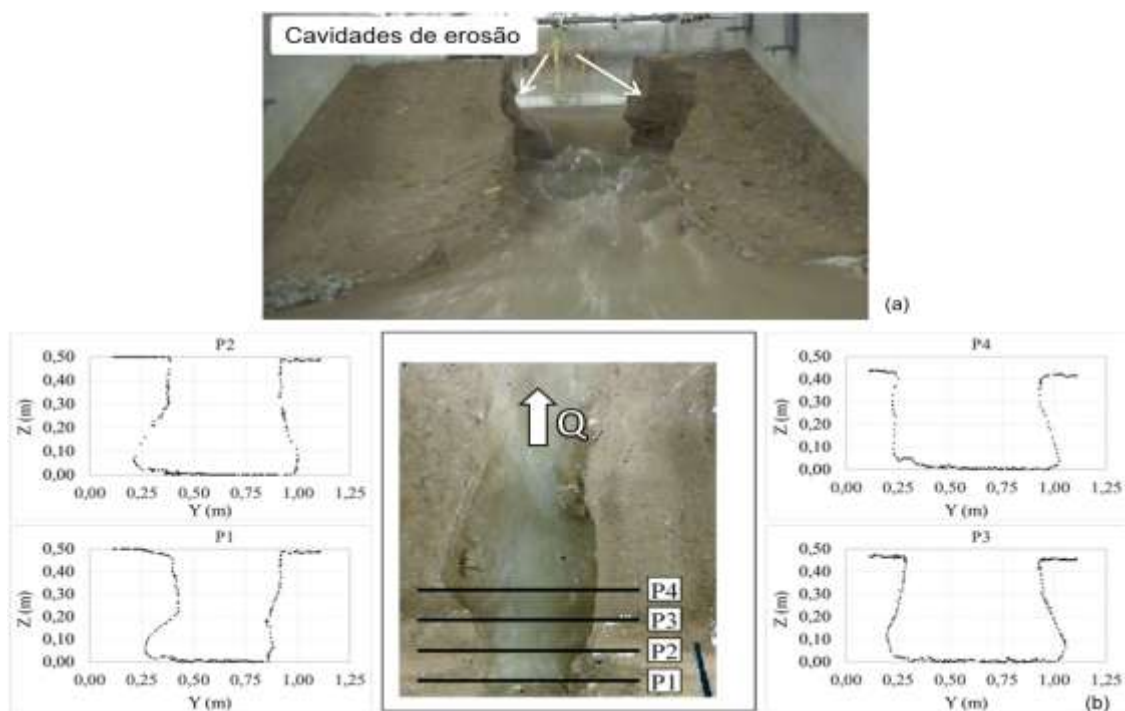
Reconstrução da barragem em rotura com o Kinect sensor. (a) vista frontal do paramento de jusante da barragem com 2 cavidades de erosão; (b) vista em planta da barragem (nuvem de pontos) com sinalização do local dos perfis transversais P1 a P4
